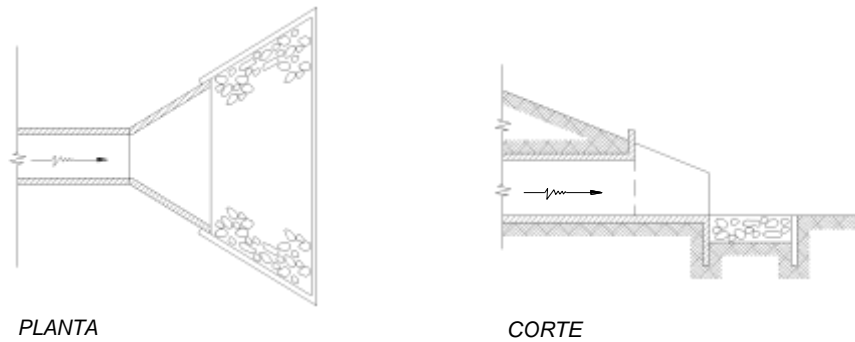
Terminal de alcantarilla con batea de hormigón
